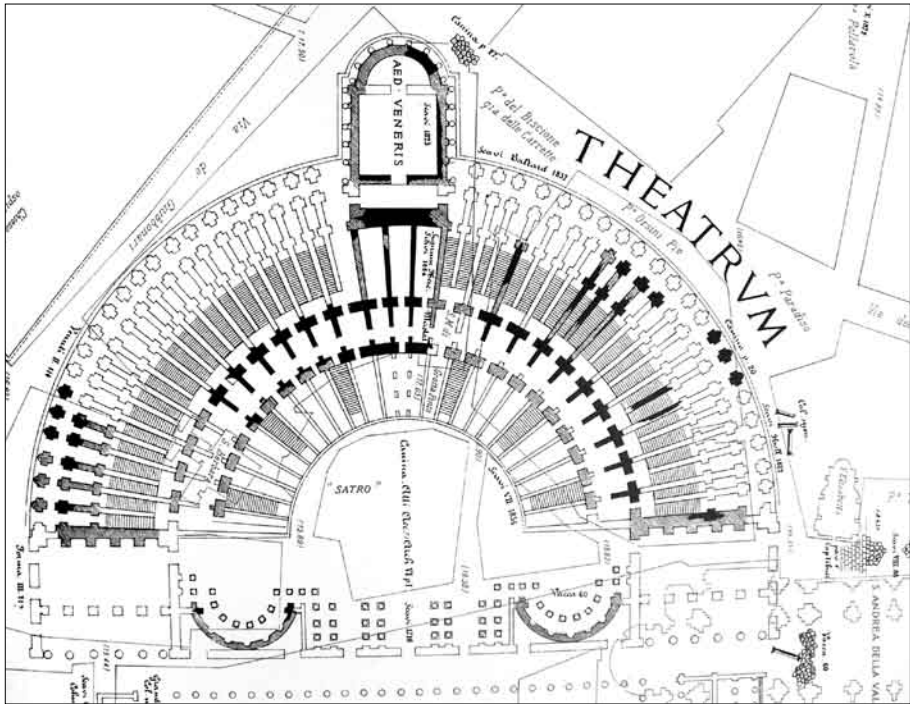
Teatro de Pompeyo. Planta de R. Lanciani.
